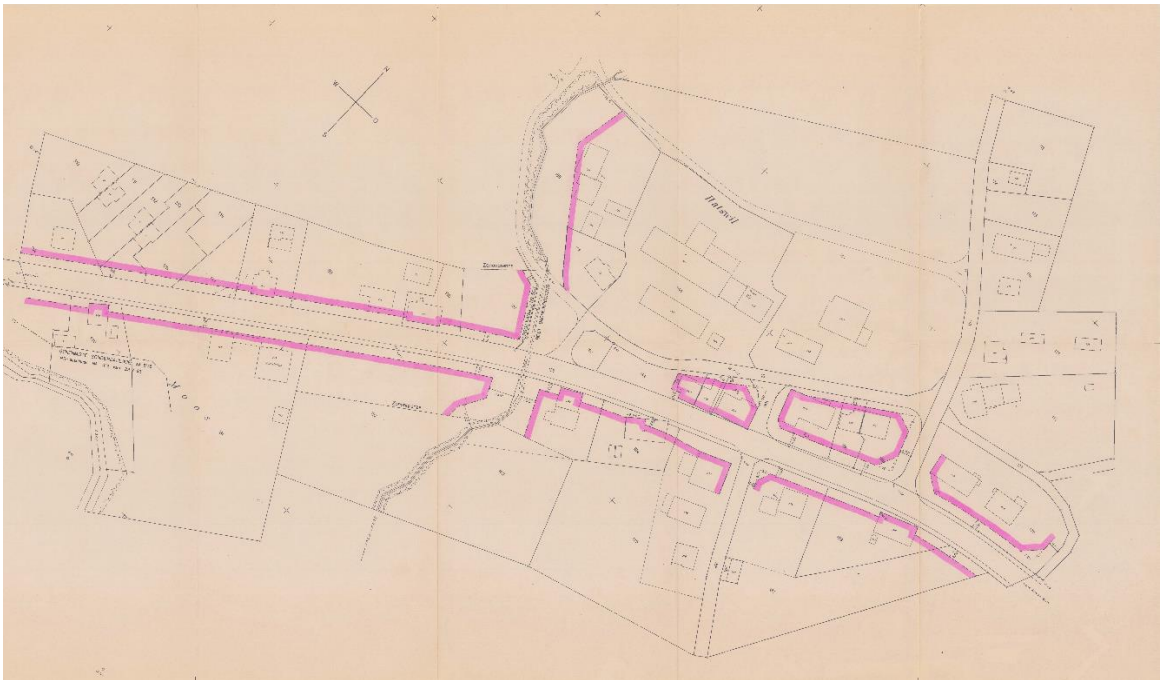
Ausschnitt des Baulinienplans längs Staatsstrasse und Schuelbach Hatswil-Mitte.
